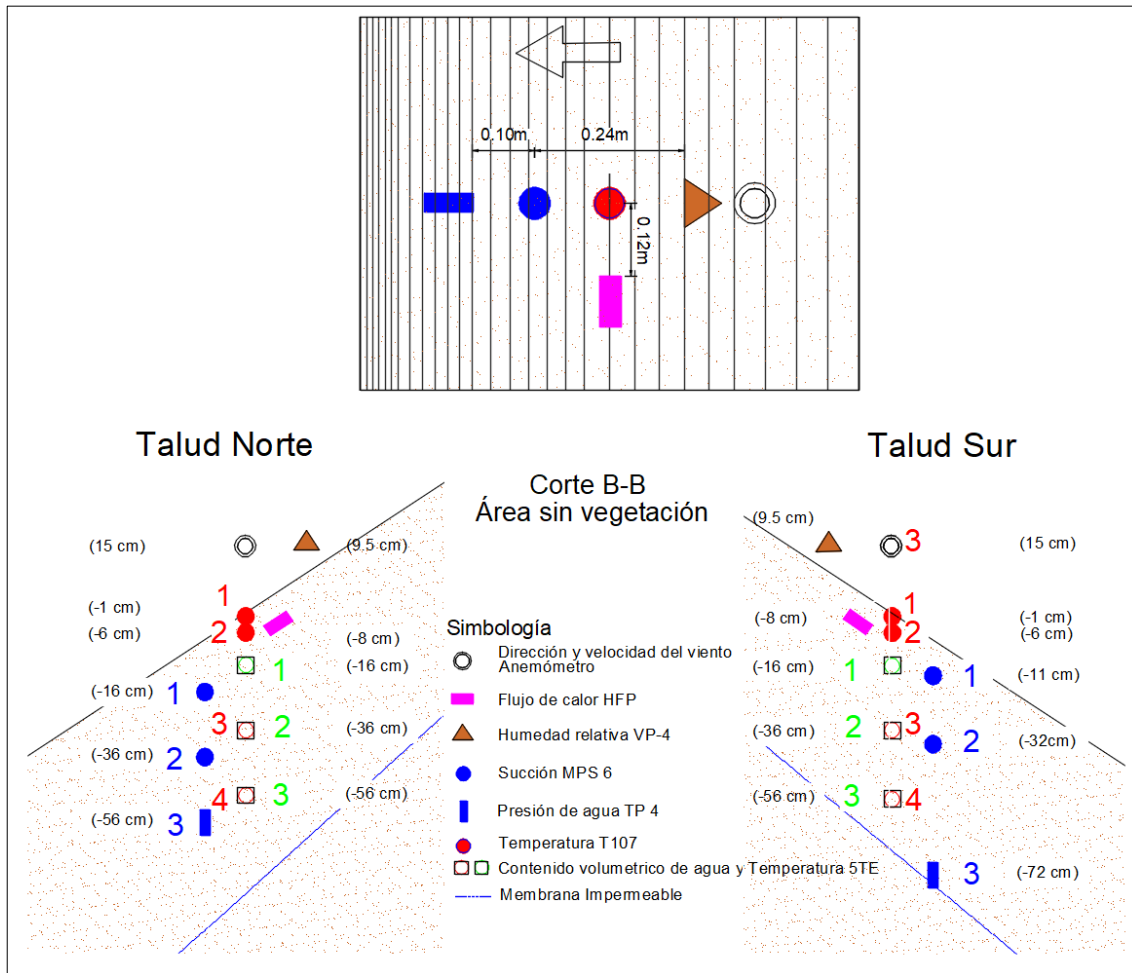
Ubicación de sensores en planta y perfil del área sin vegetación (perfil B-B).
